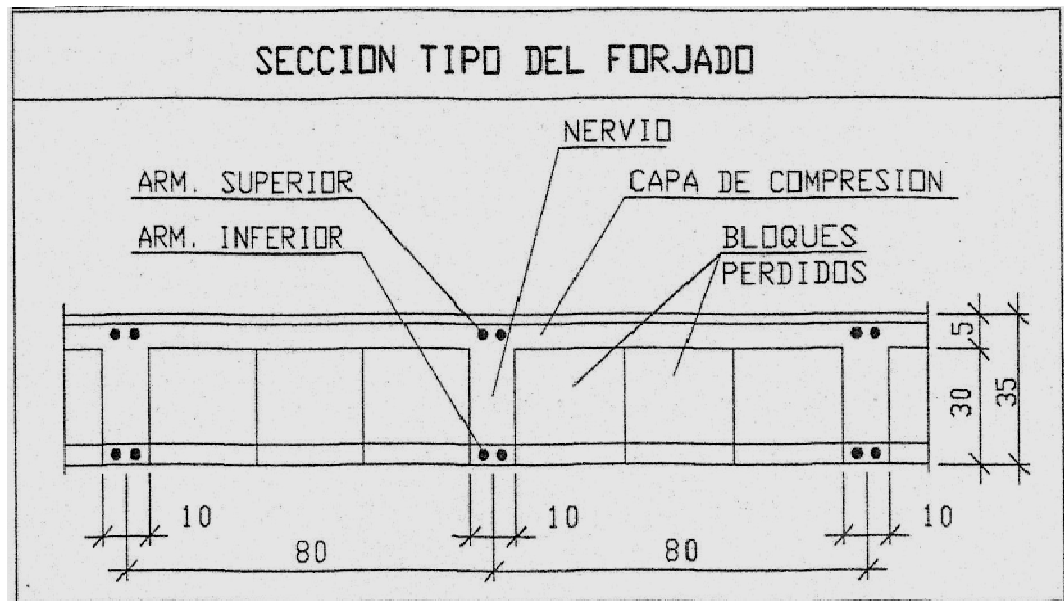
Sección tipo de forjado reticular del edificio de la calle Infante
